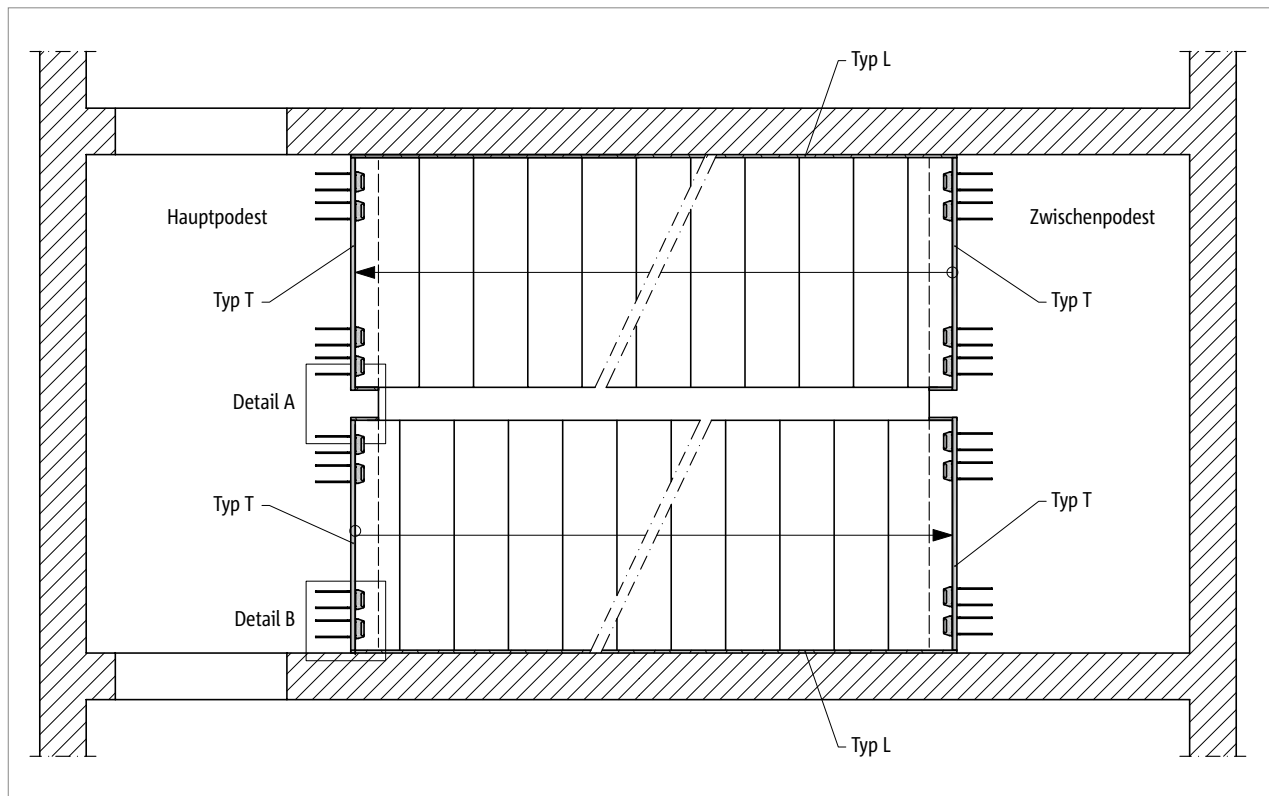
Schöck Tronsole® Typ T: Elementanordnung im Grundriss
